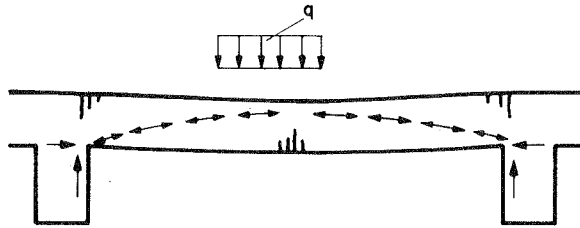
Gewölbewirkung in durchlaufenden Stahlbetonplatten
